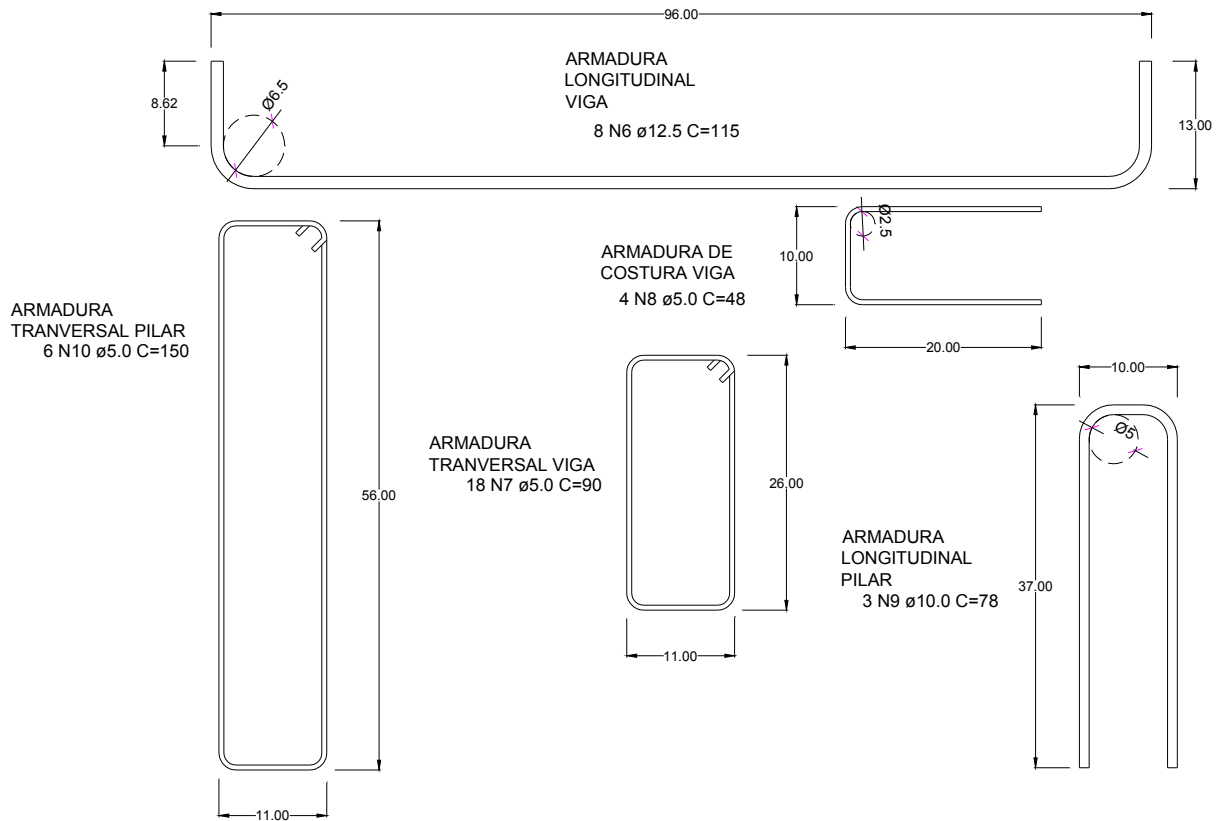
Detalhamento das armaduras para o modelo 4.
